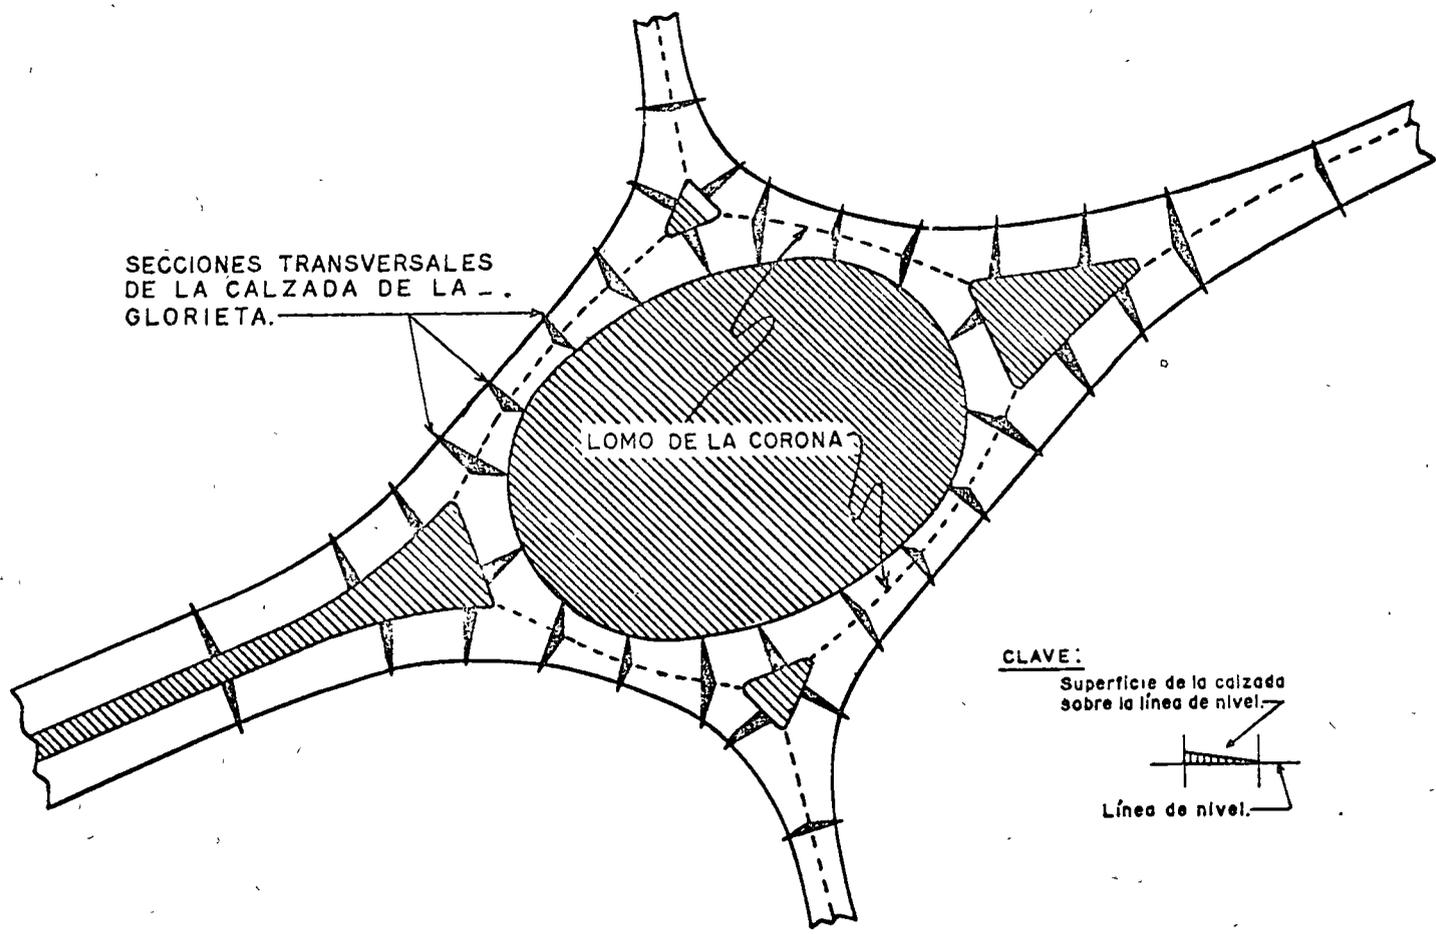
PENDIENTE TRANSVERSAL DE LA CALZADA
